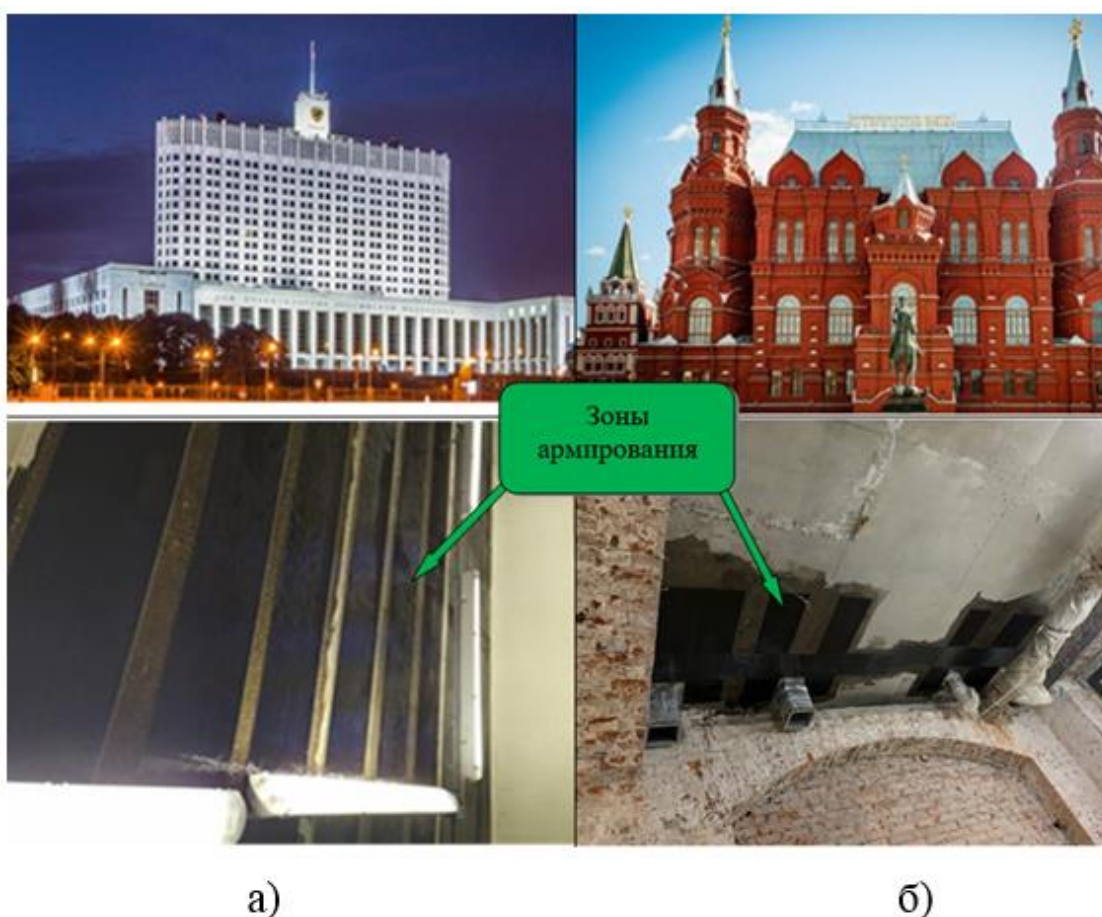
Усиление железобетонных плит перекрытий Дома Правительства РФ (а) и Государственного исторического музея (б)
